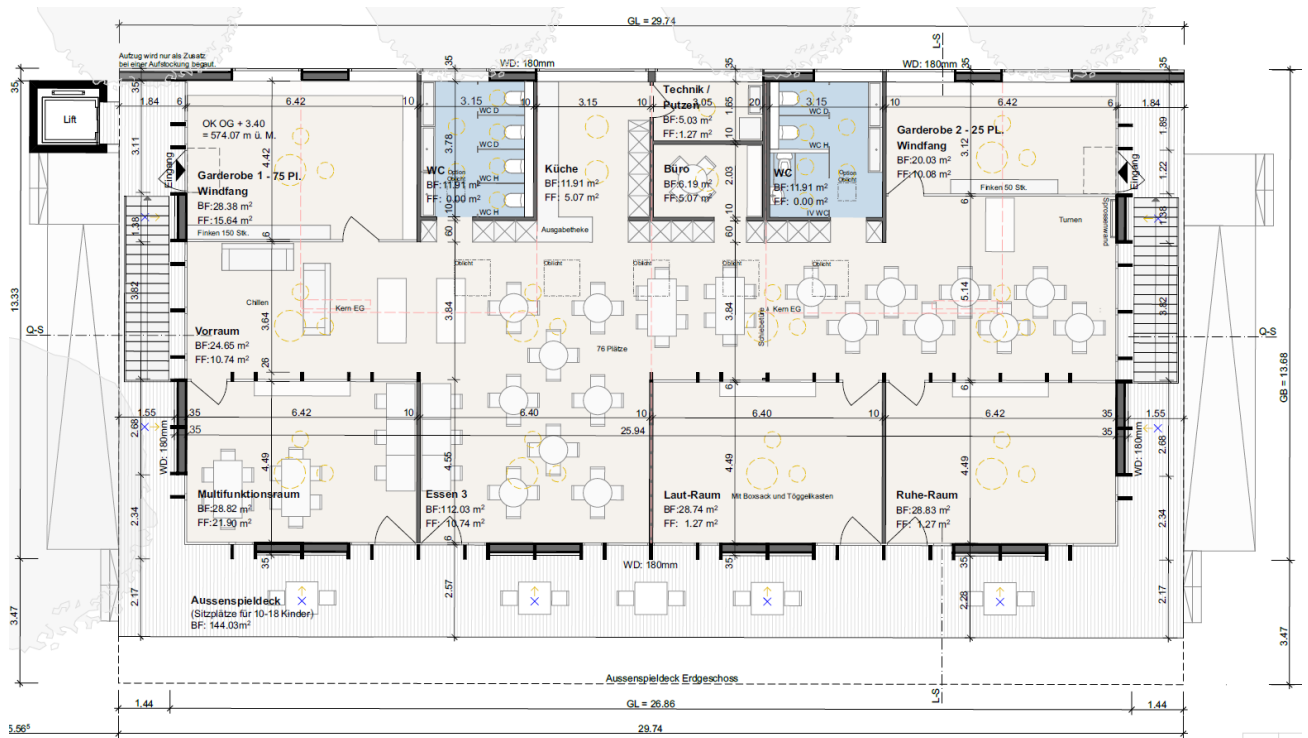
Grundriss Tagesschule im 1. OG
